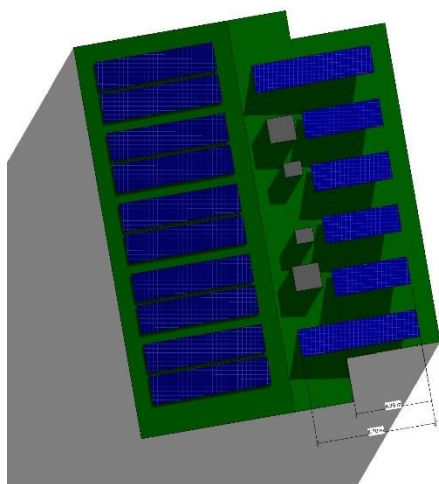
Edificio 4 con fotovoltaica coplanar en cubierta oeste. (Elaboración propia)
